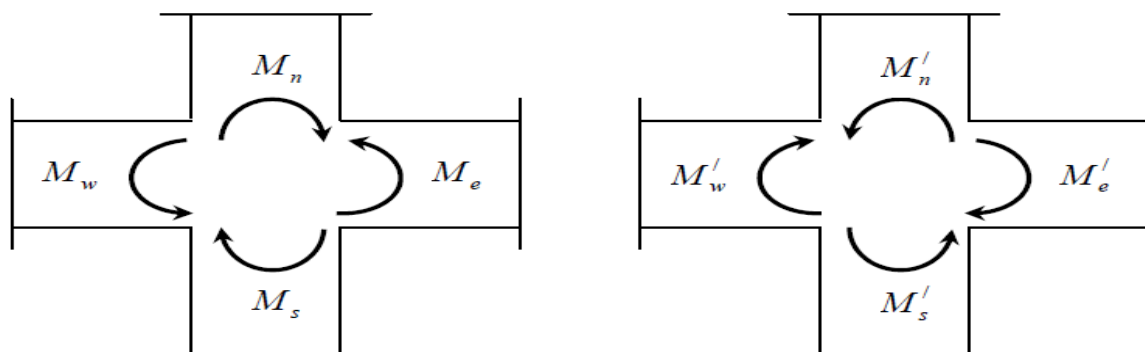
Dimensionnement d'un nœud poutre – poteau [8].
